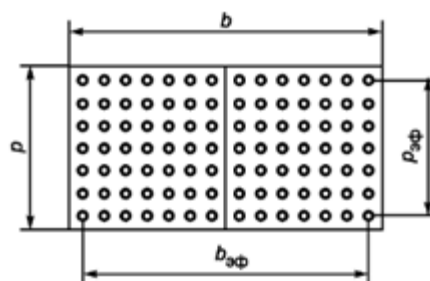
Тактильная плитка перед входом в здание с лестницей
